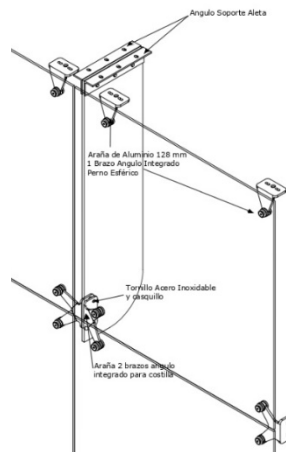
Sistema de soporte de muro cortina de vidrio templado. Fuente: la autora (2022).
